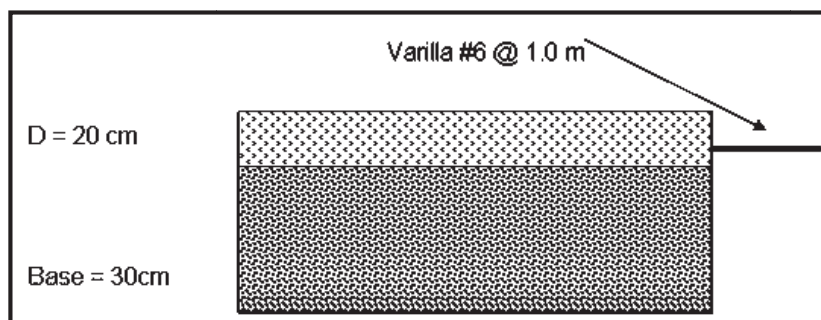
Diseño del Pavimento a utilizar.
